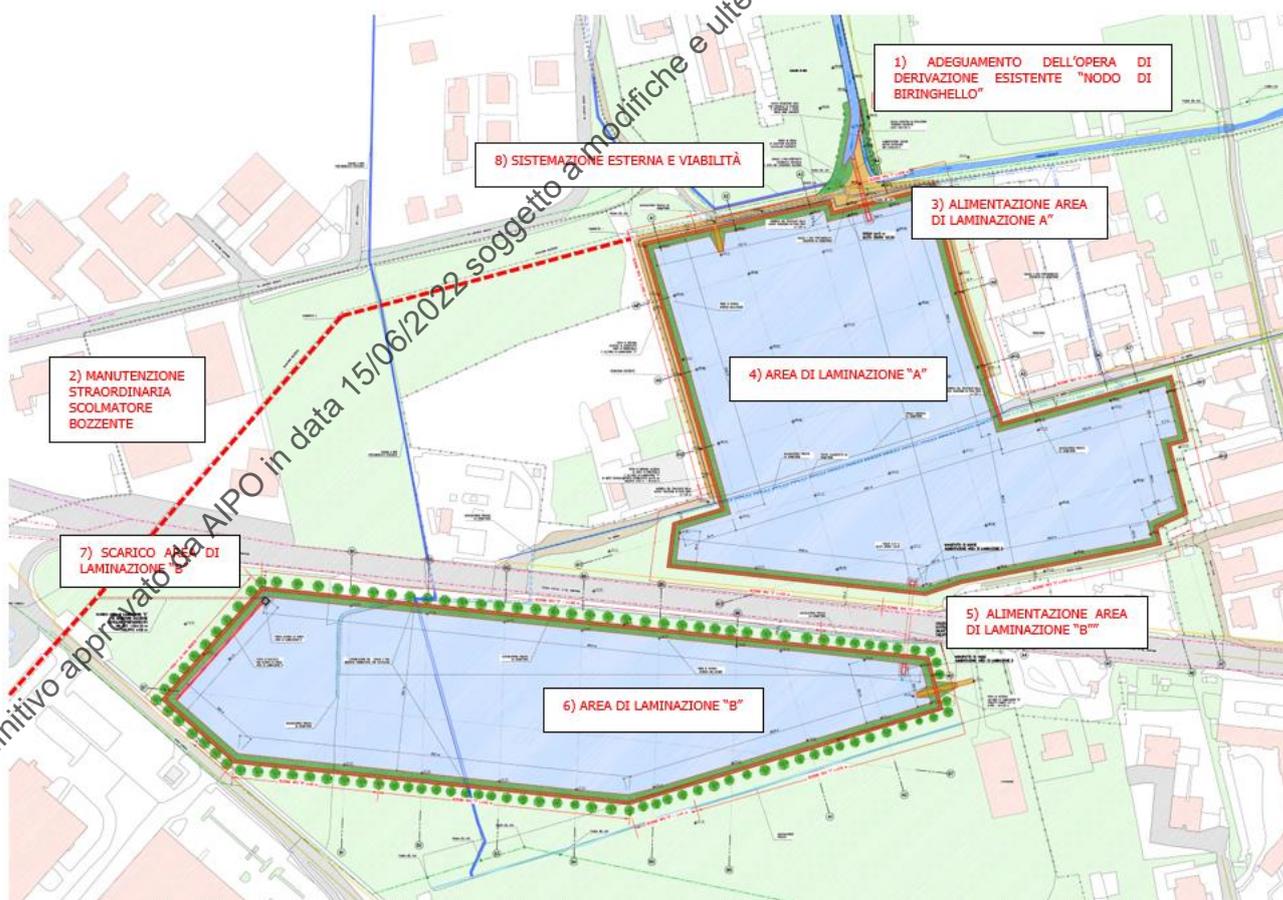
estratto planimetrico degli interventi in progetto: keymap
